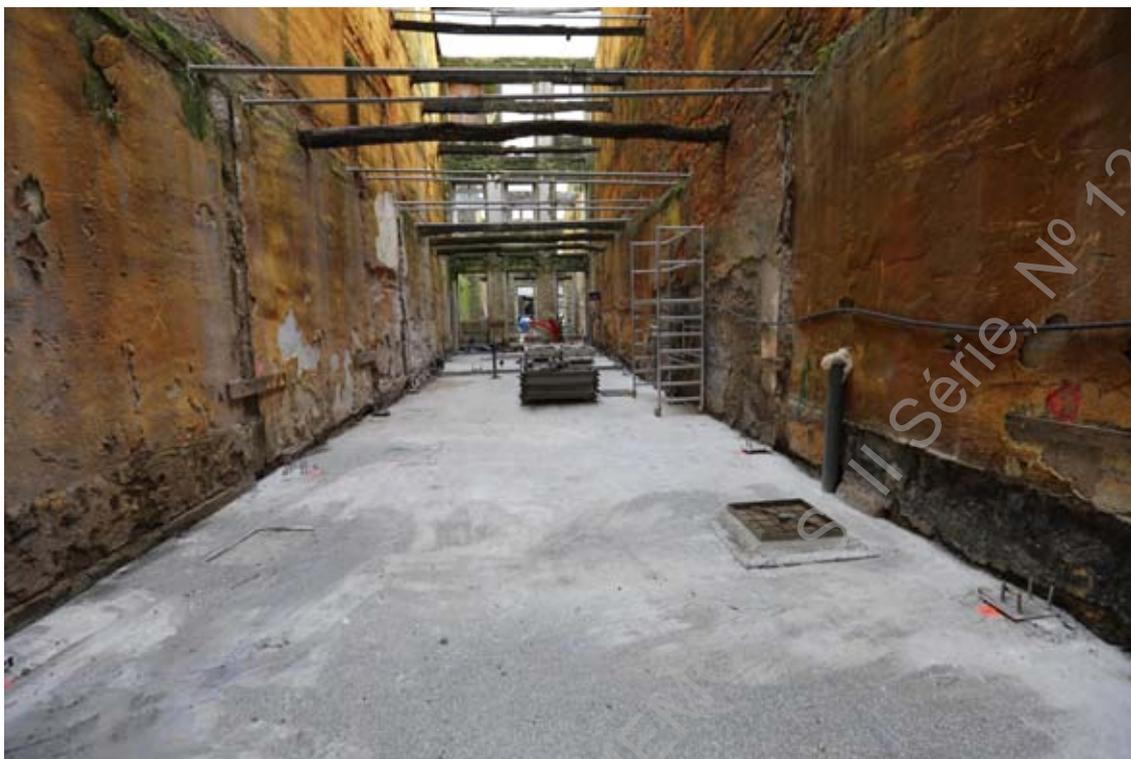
(IMG_4309) – Aspeto final da betonagem do lote.
